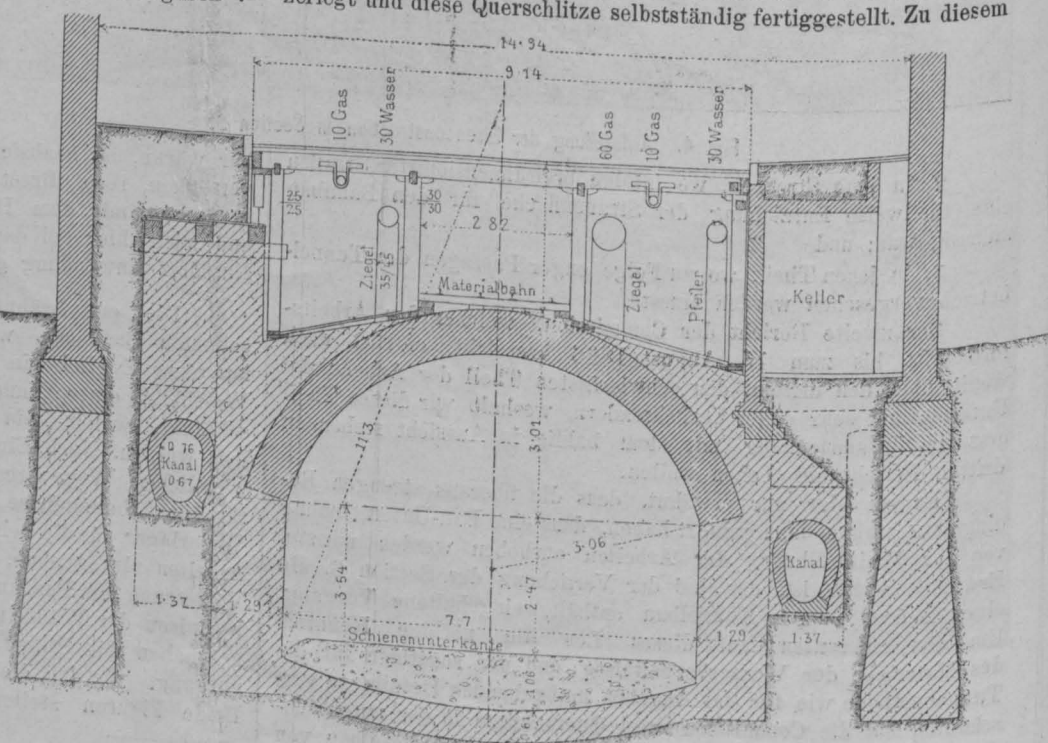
Querschnitt in Cannon Street mit dem fertigen Tunnel.
